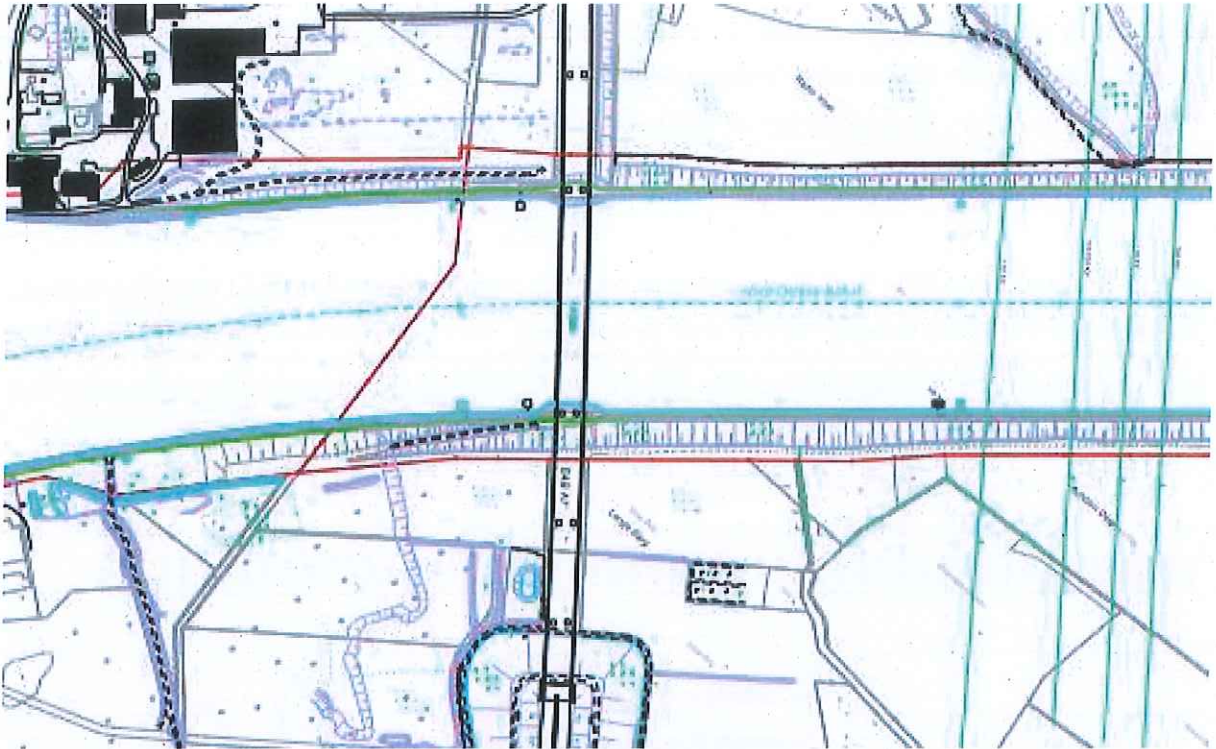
Trassierung im Bereich der Rader Hochbrücke, Ausschnitt aus [U4]
